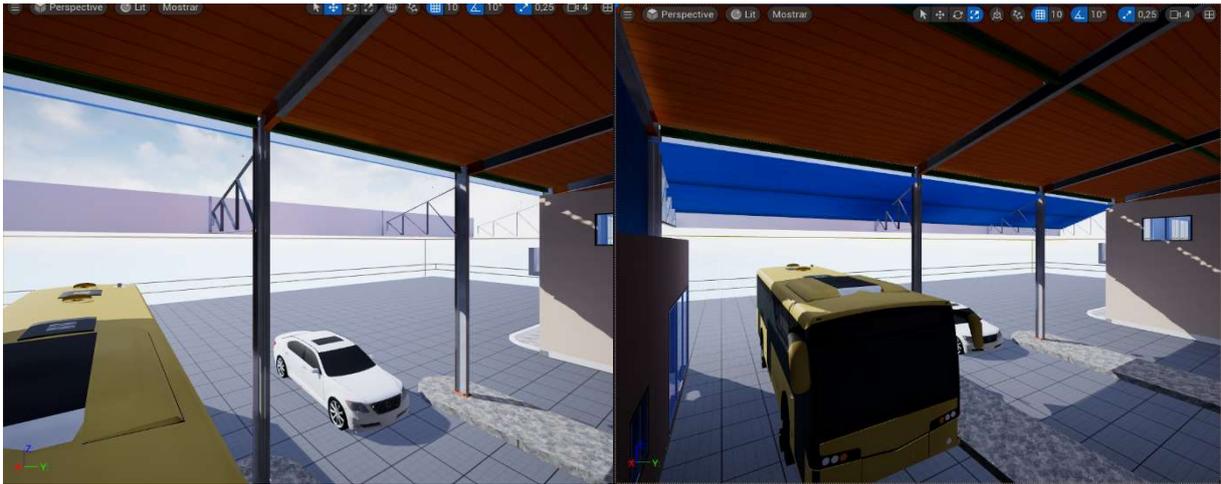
Arreglos en placas de acero galvanizado de la cubierta. Fuente: Elaboración propia.
